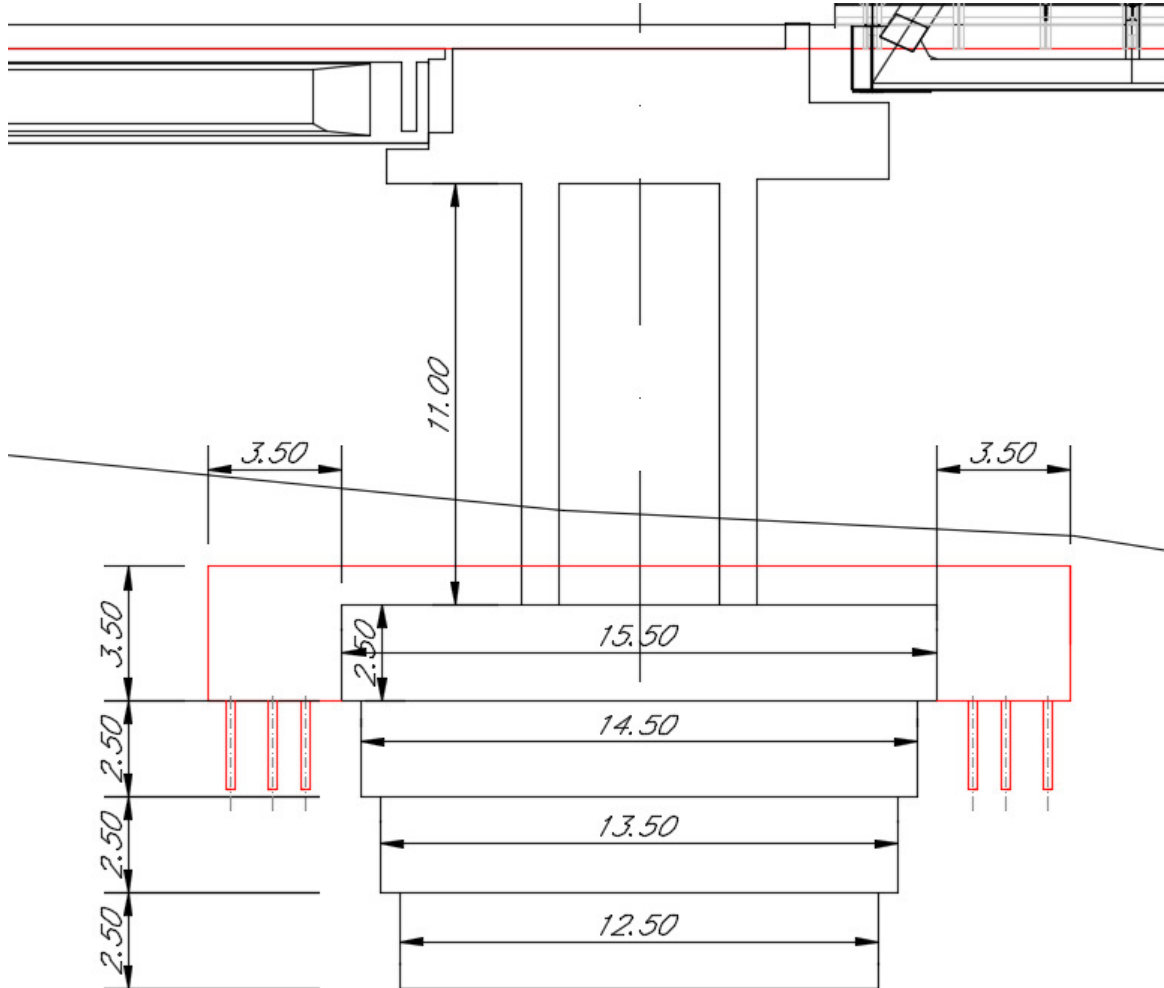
Pila P2, P3 – Configurazione di progetto di miglioramento sismico – sezione
